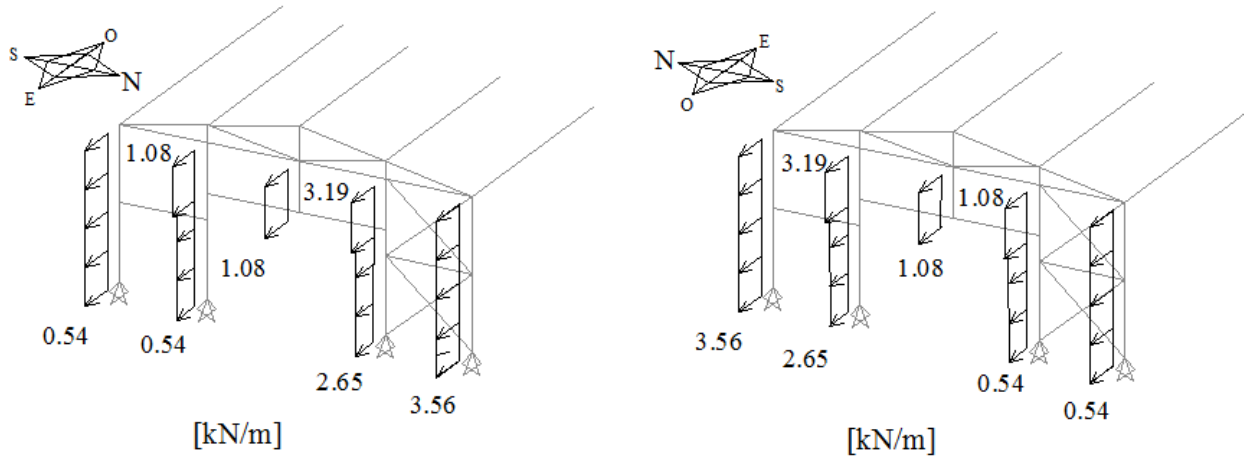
Vento W1 nas fachadas orientadas a Este e Oeste na situação 1 (EC1.1.4)
